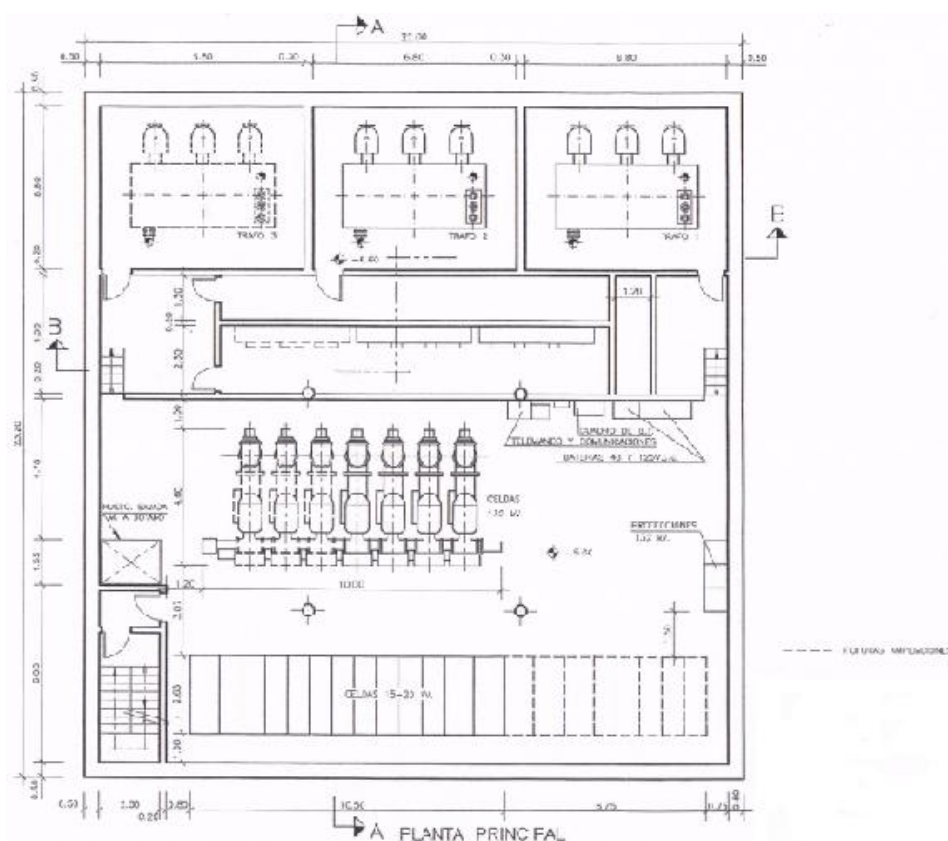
Plano de la planta principal de una subestación blindada rural de 66/20 kV.
